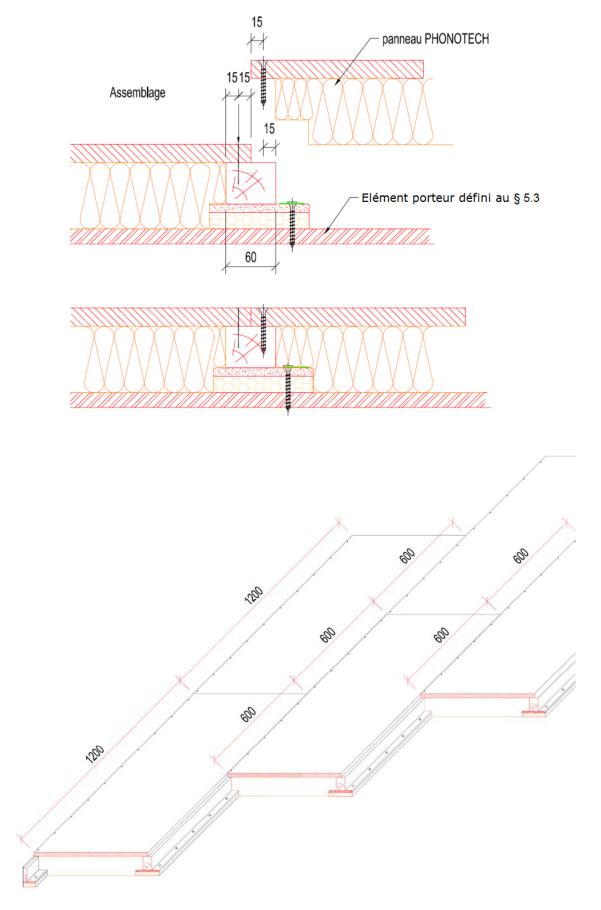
Fixation du panneau PHONOTECH sur la règle de montage du panneau PHONOTECH précédent
